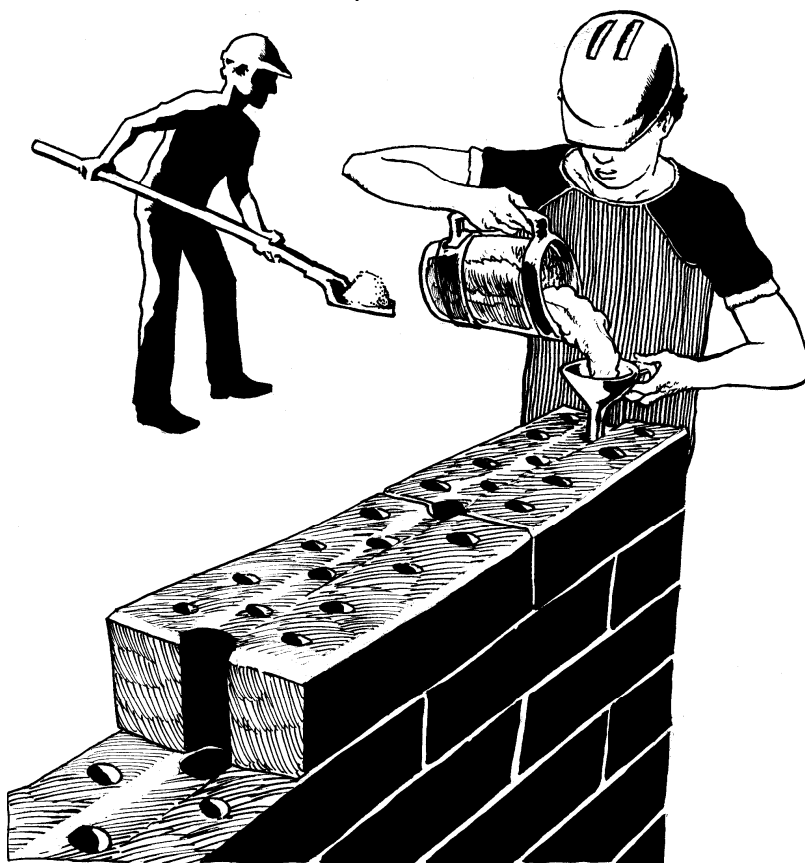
Construção de paredes com o emprego de tijolos especiais
